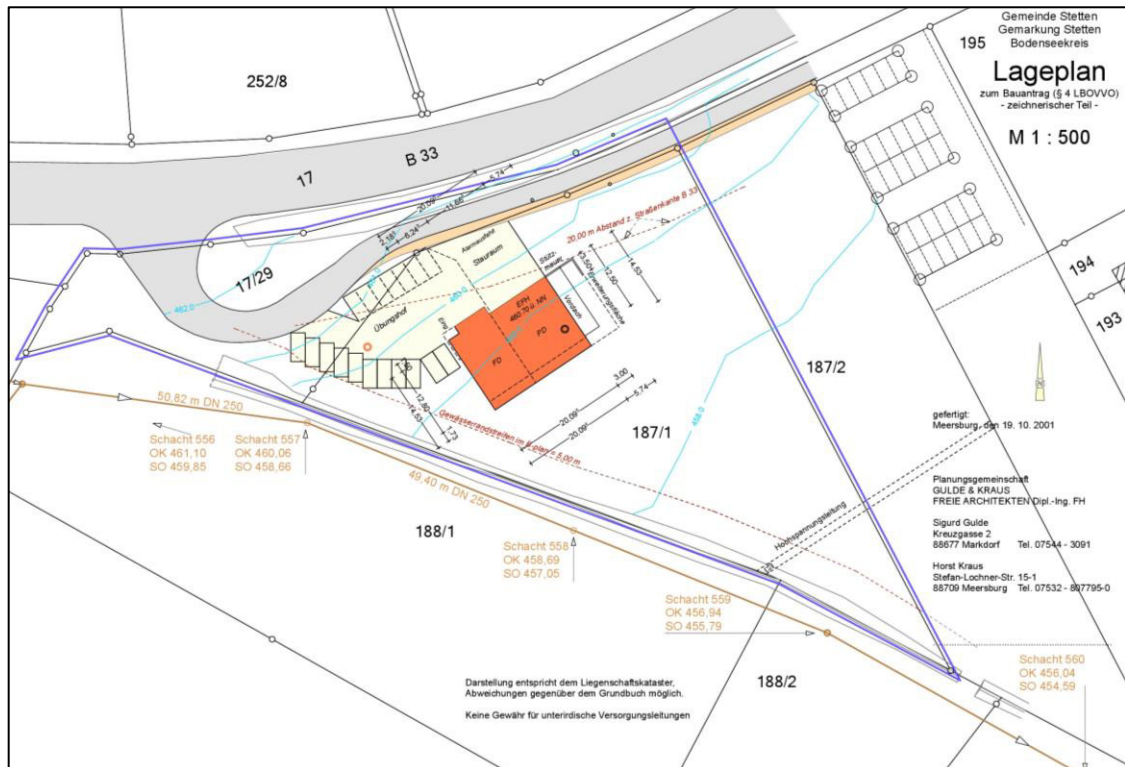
Lageplan Feuerwehrhaus, ohne Maßstab [5]
